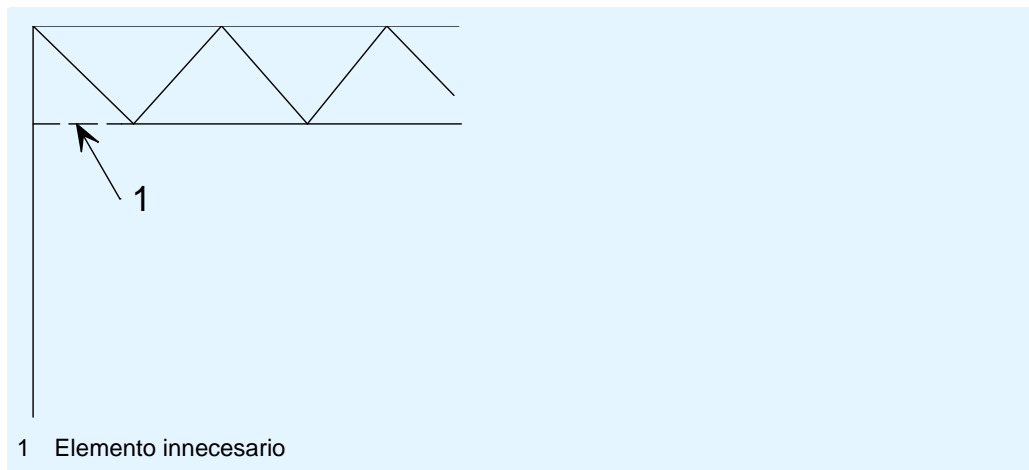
Elemento innecesario en una unión articulada de una celosía simplemente apoyada sobre pilares
